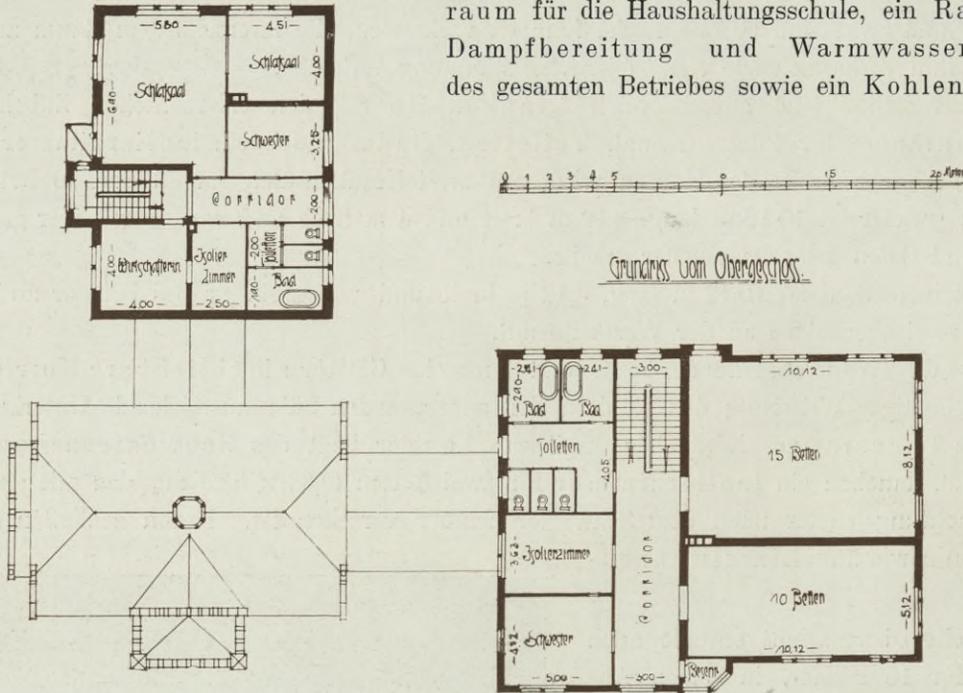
Hauswirtschaftsschule. Hauptgebäude, Grundriß des Obergeschosses.
